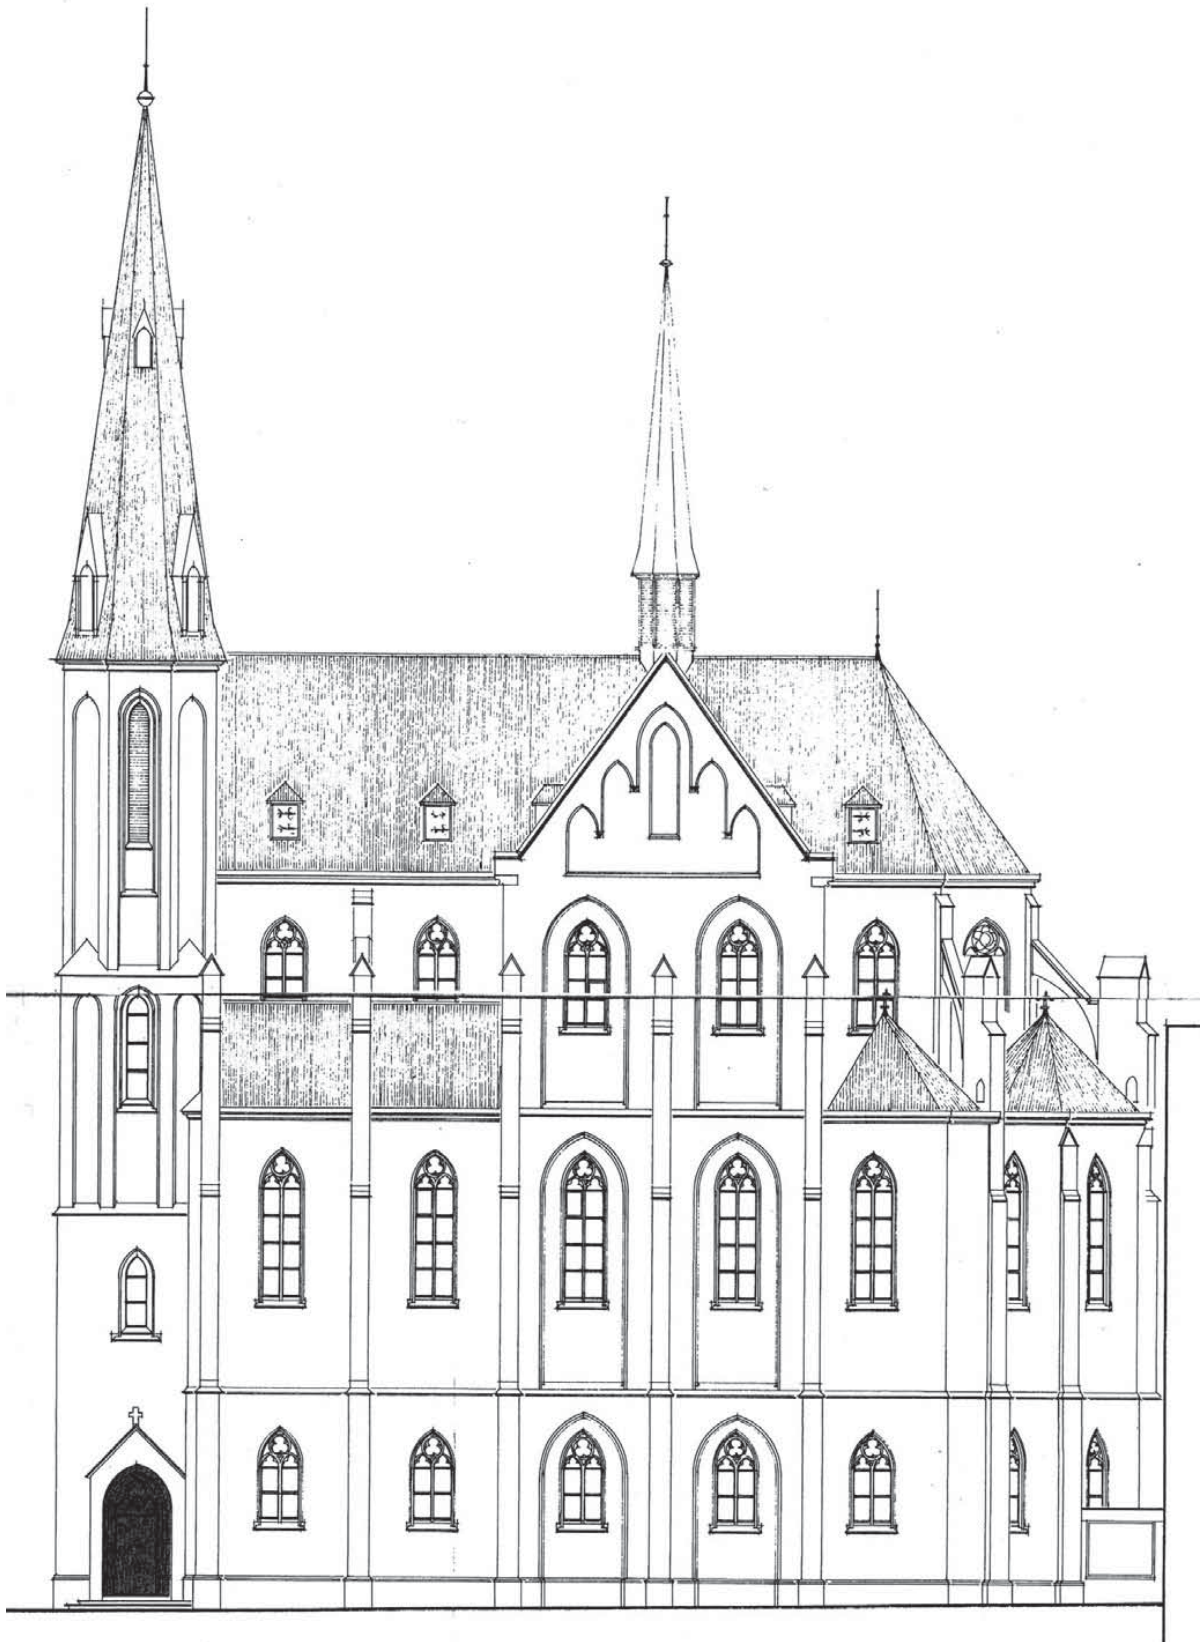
Aufriss Südfassade, aufgenommen 1995 (Maßstab im Originalplan 1:100)
